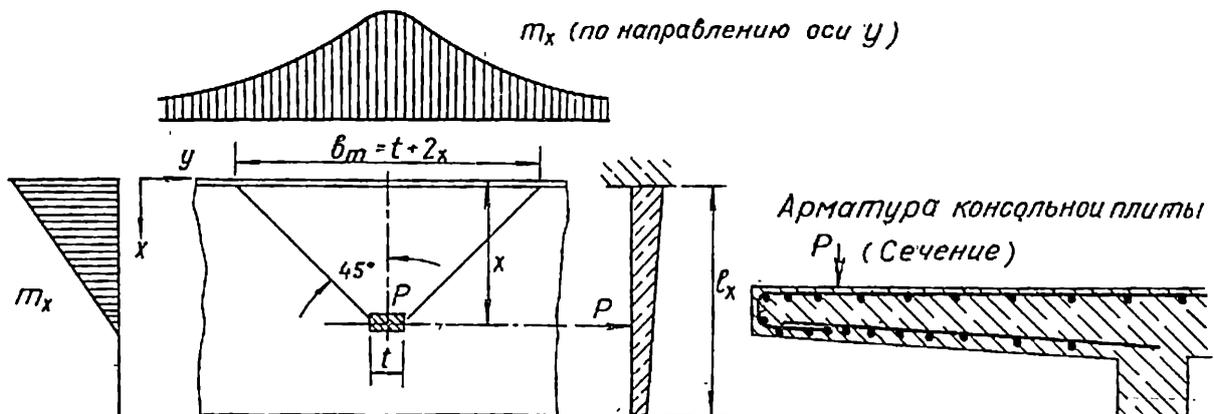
17. Расчетная эквивалентная ширина плиты при сосредоточенной нагрузке на консольных плитах
